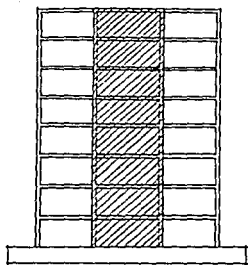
Alternativa de contravento con perfiles metálicos (Ref.15)
